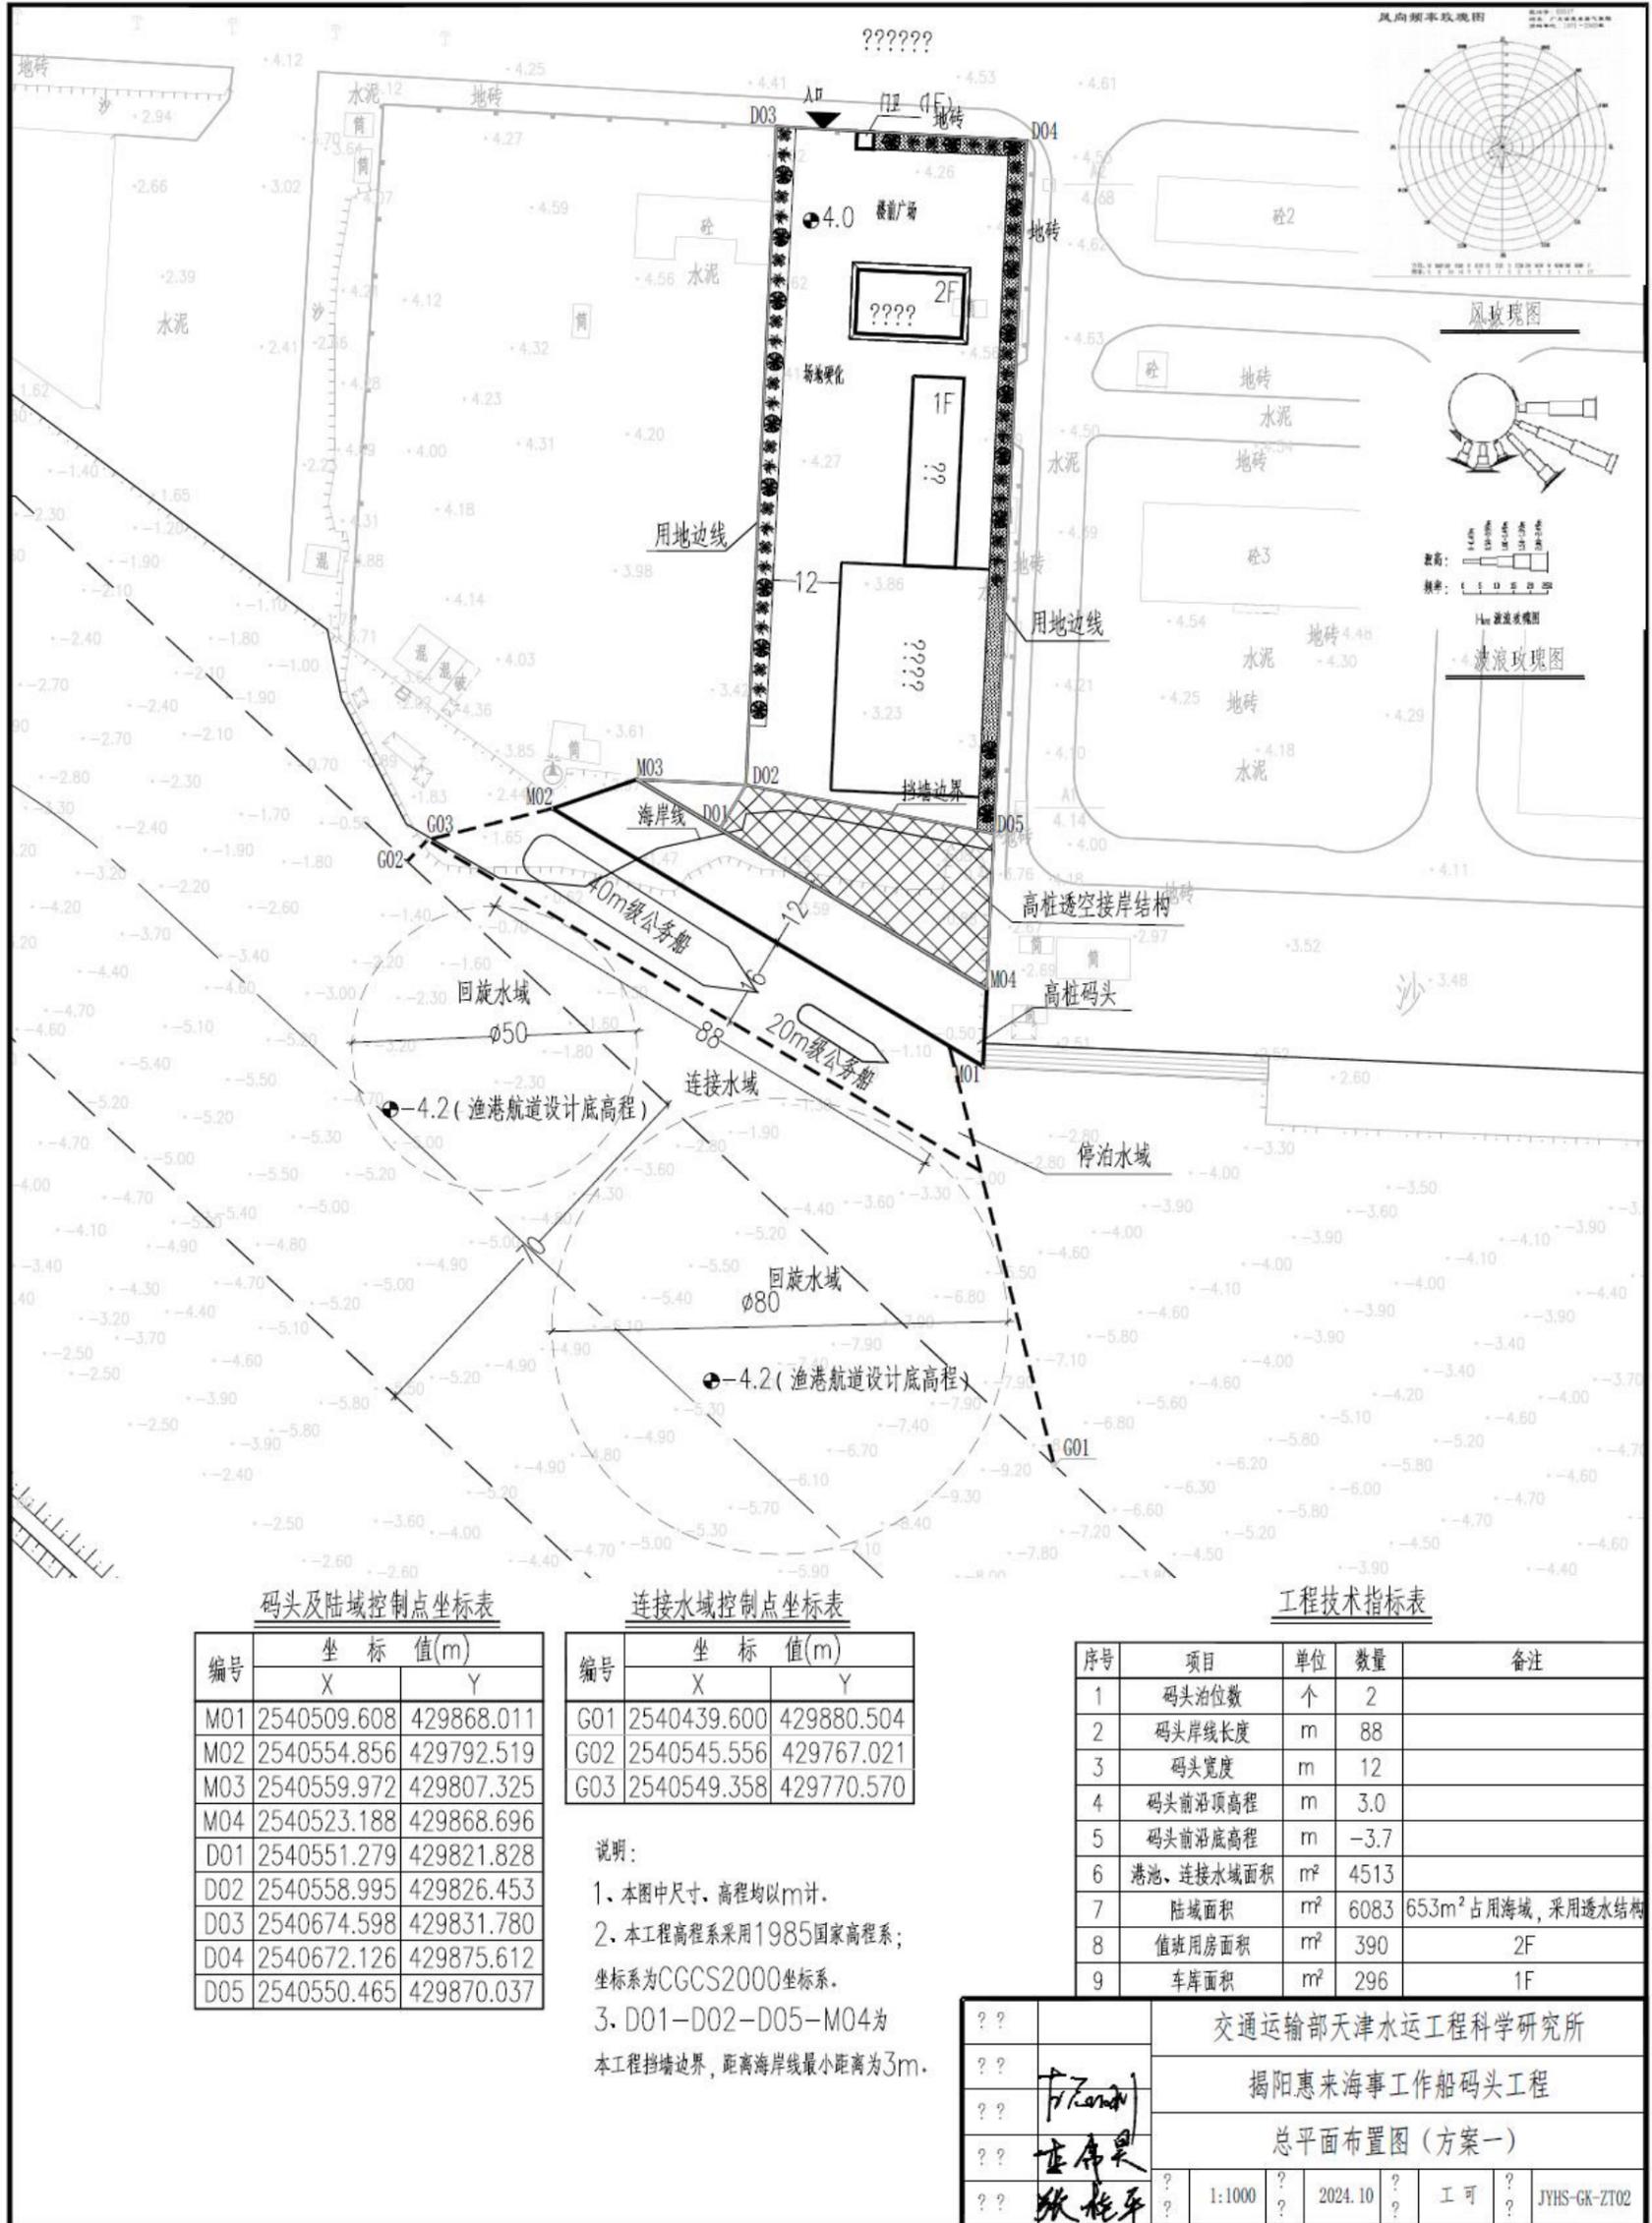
项目海域水深及平面布置图(方案一)
